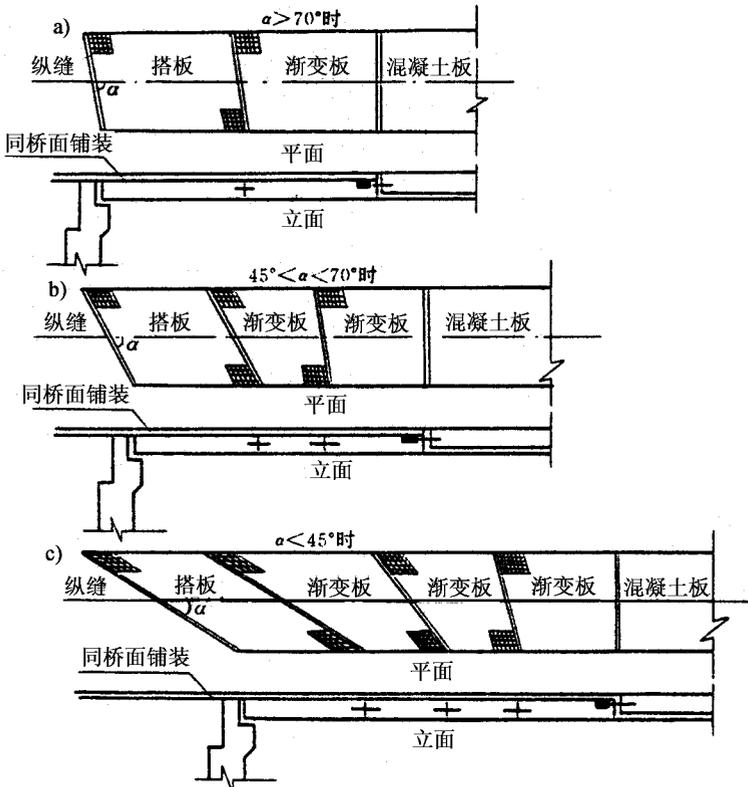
水泥混凝土路面同桥梁相接构造示意
